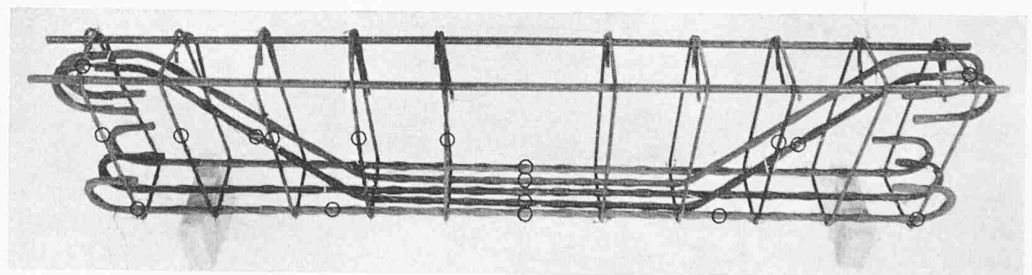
Armierungsgerüst der Balken, Typ A (Trajektorienarmierung)
